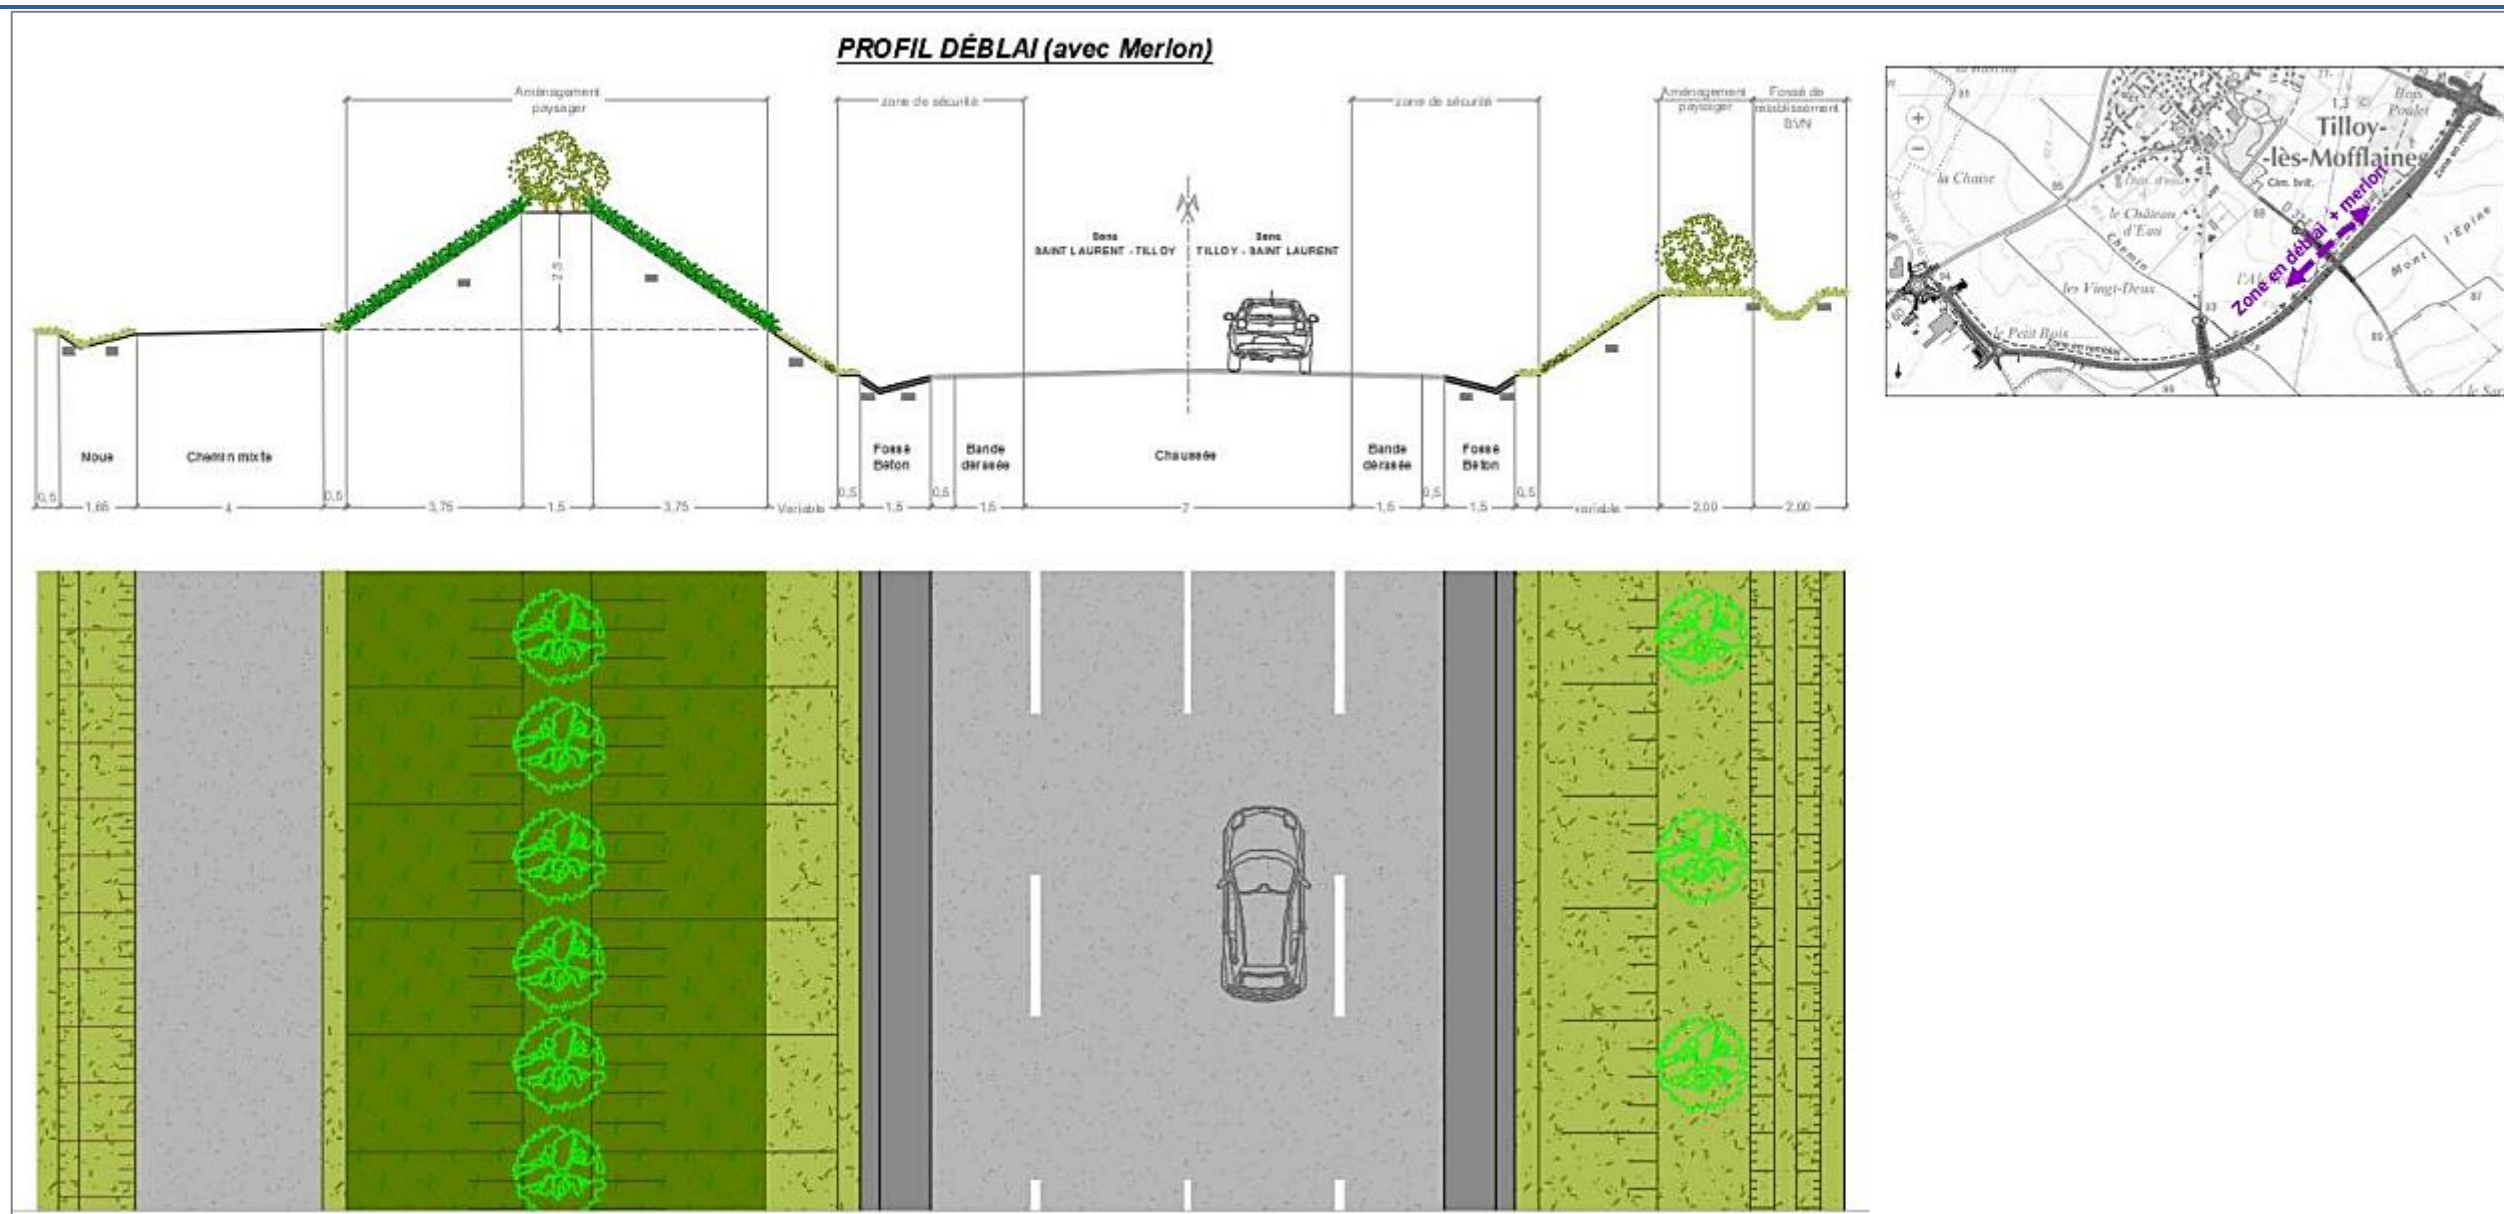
Profil en travers en déblai de la section courante avec merlon (avec aménagements paysagers)
